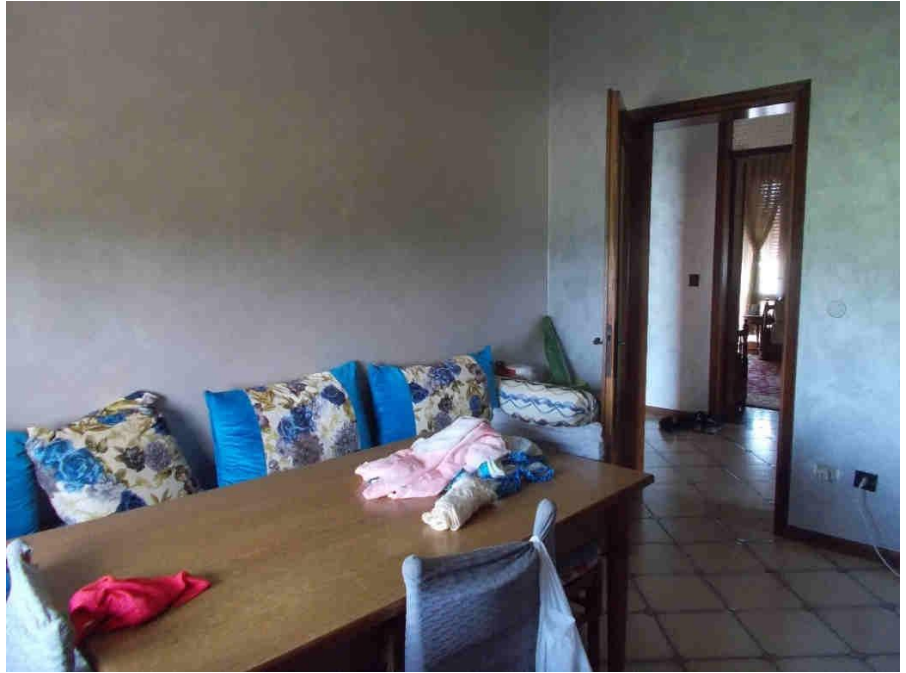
P. 1. – Ingresso abitazione (da sanare)
